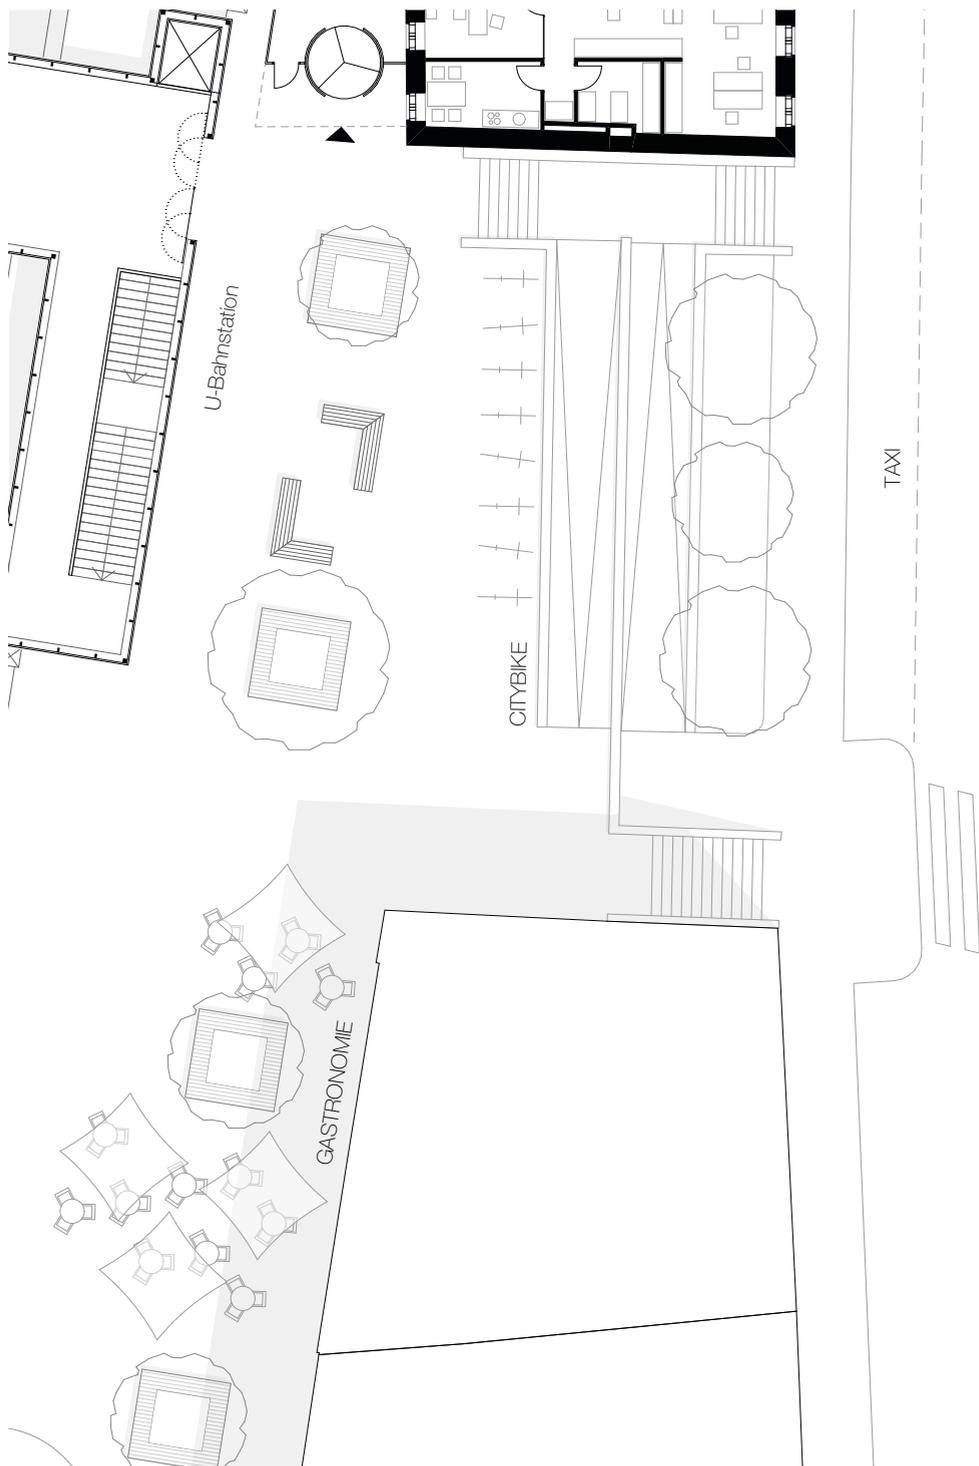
; Grundriss, Vorplatz, 1:500
